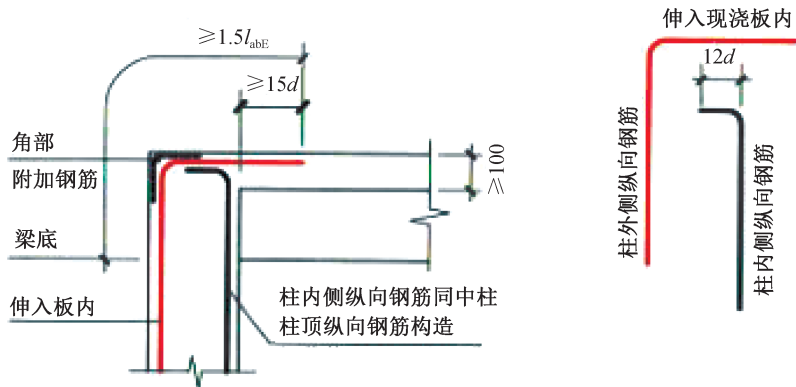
柱外侧纵向钢筋和梁上部纵向钢筋在节点外侧弯折搭接构造
